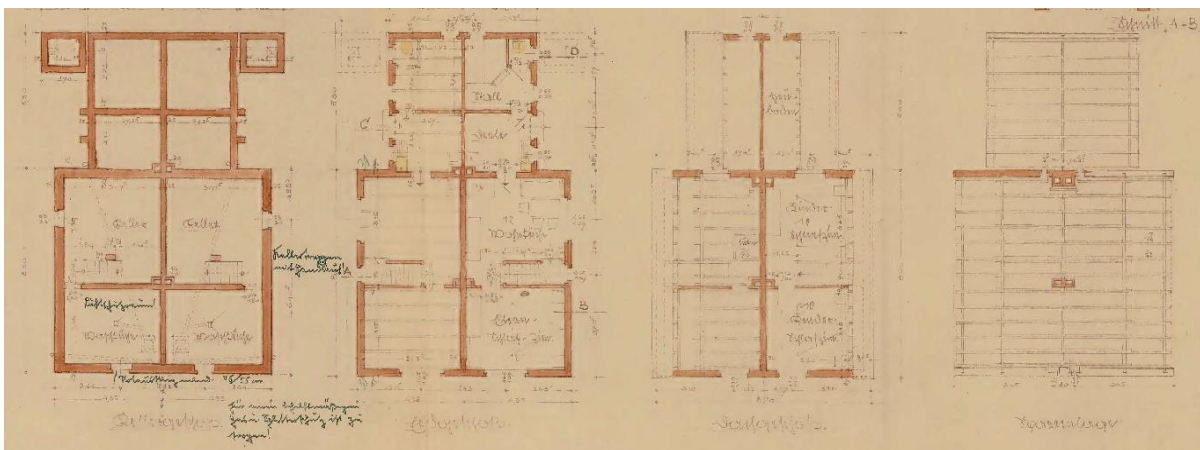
Nach Originalplänen: Grundrisse des Haustyps 21 A (Typ A)
